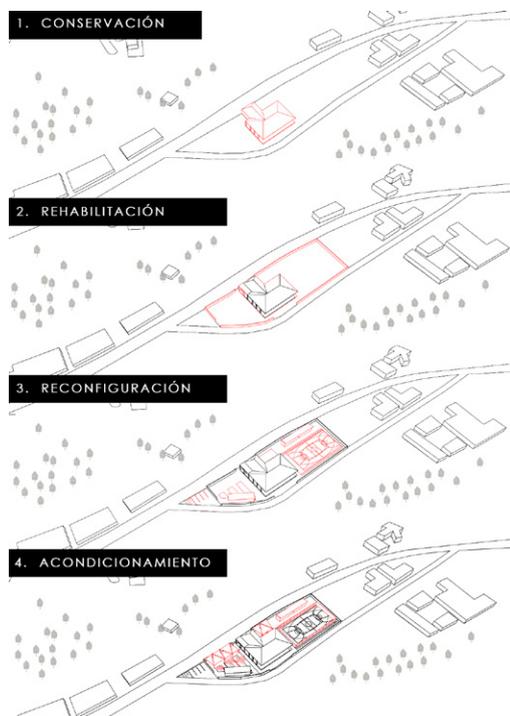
| Etapas del plan de rehabilitación. Fuente: elaboración propia.
